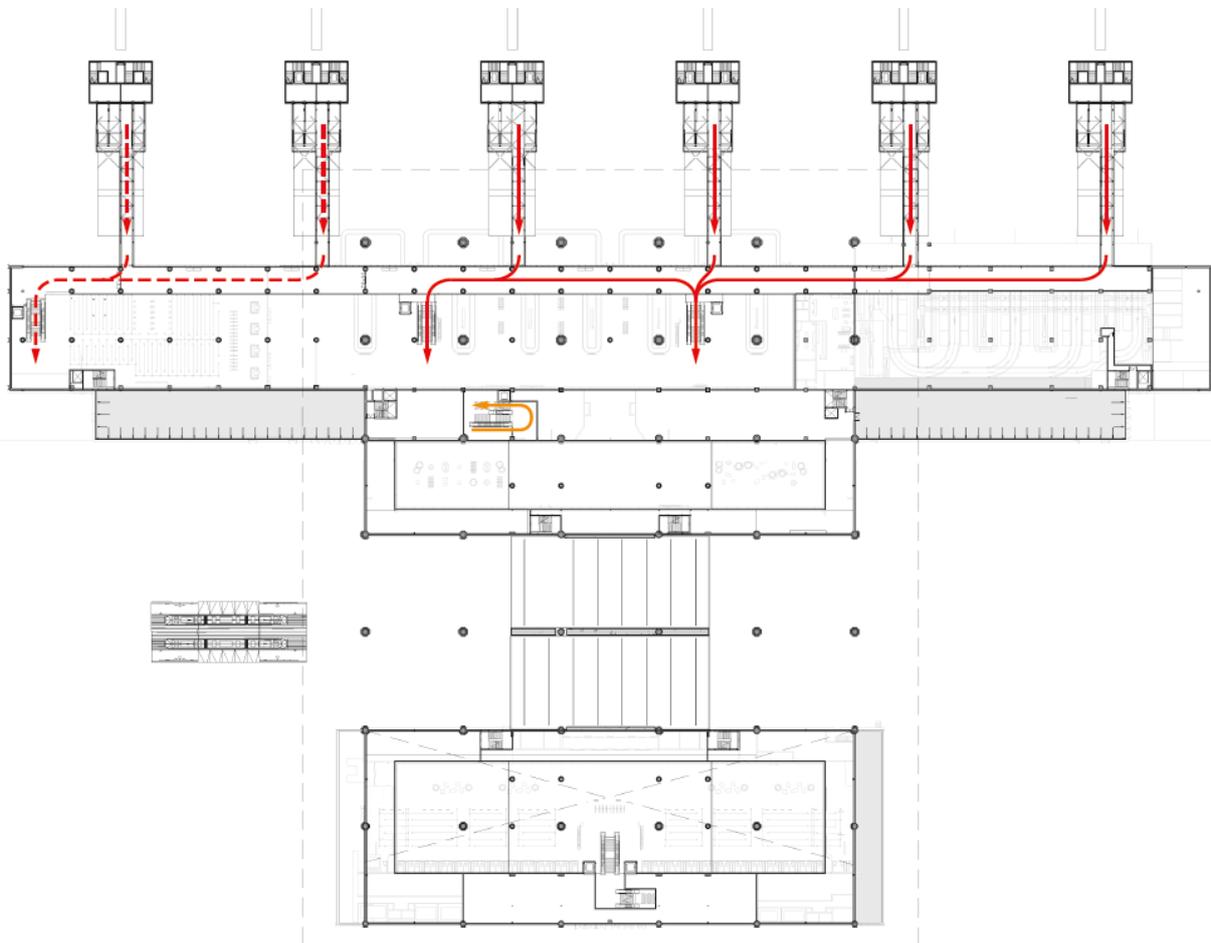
| Pianta del mezzanino 2035 circolazione ed aree tecniche
